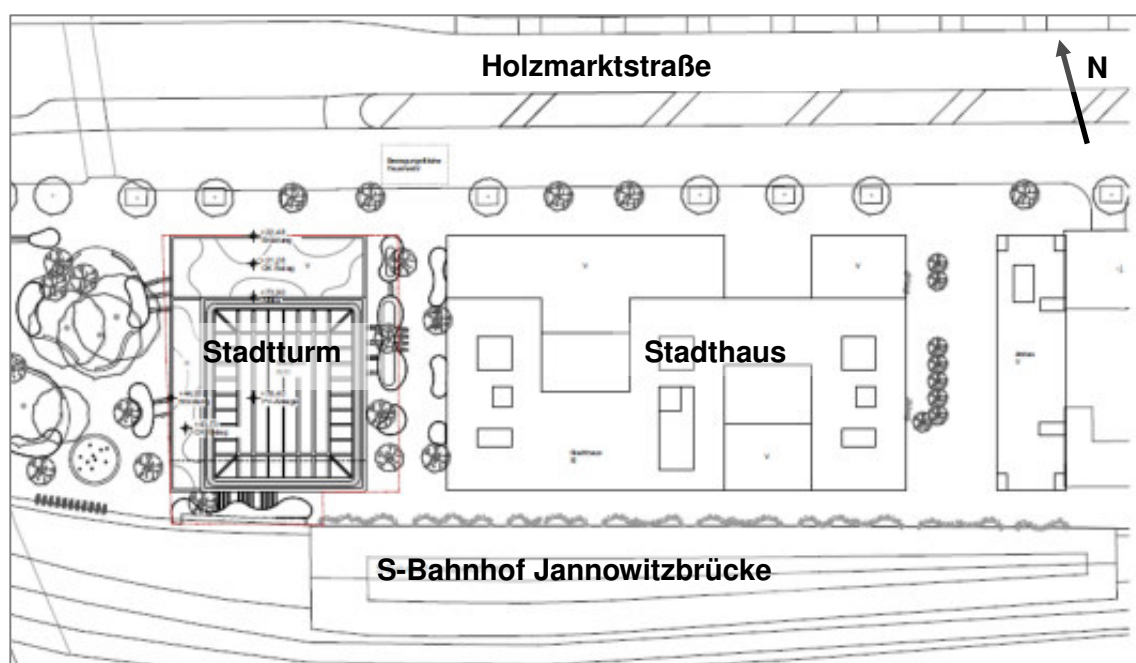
Übersichtplan mit Darstellung des Stadtturmes und Stadthauses
